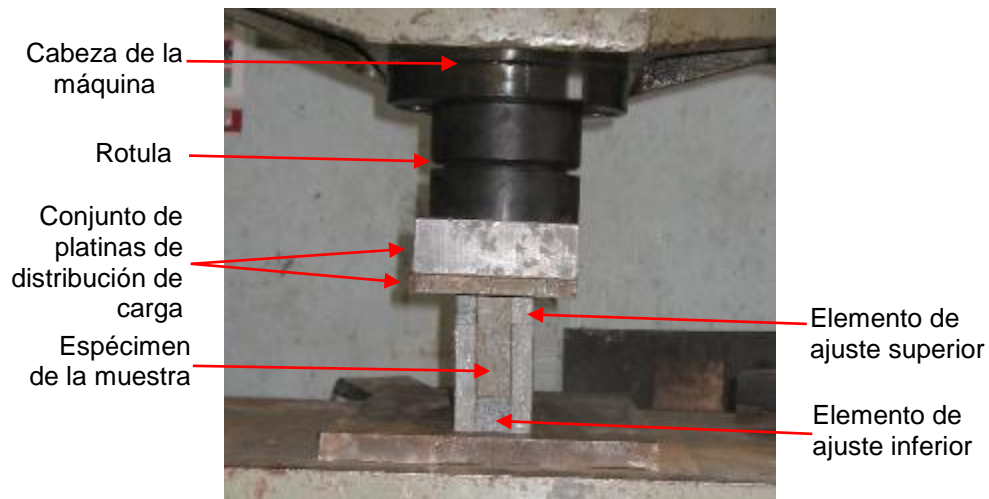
Montaje ensayo a compresión en bloques Brickarp® vista frontal. Fuente: Autor
